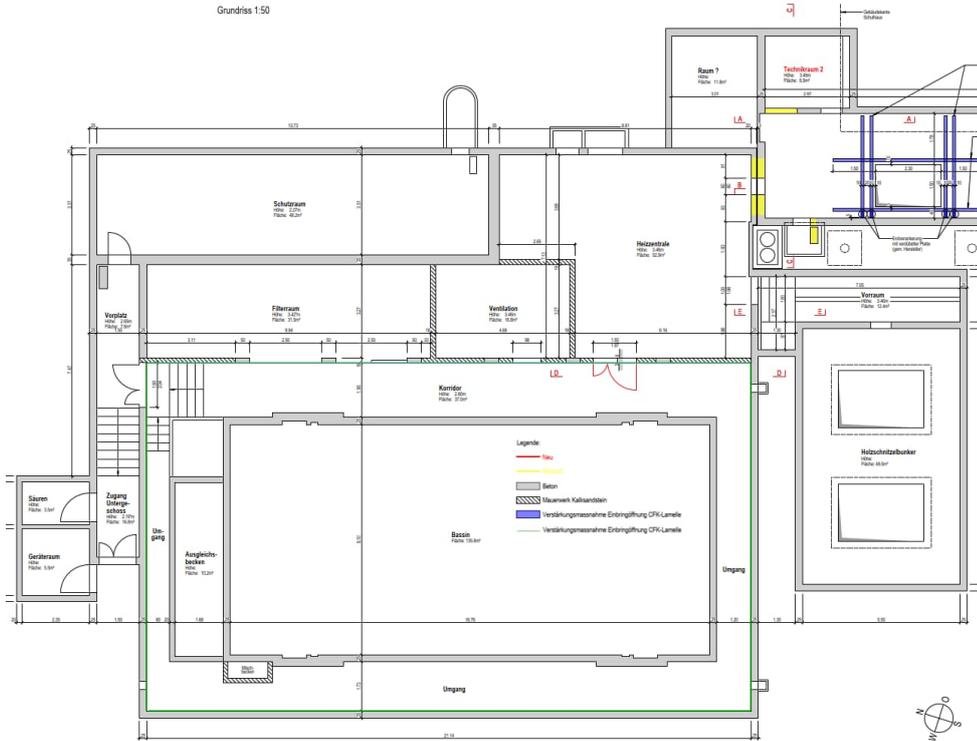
Tragsystem Grundriss Untergeschoss
